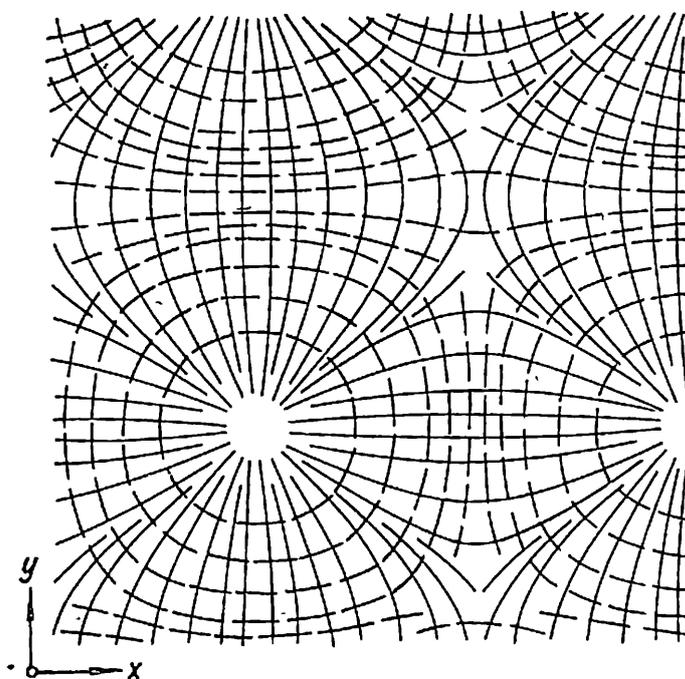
35. Направления главных моментов у плоских плит перекрытий на отдельных опорах под воздействием равномерно распределенной нагрузки
